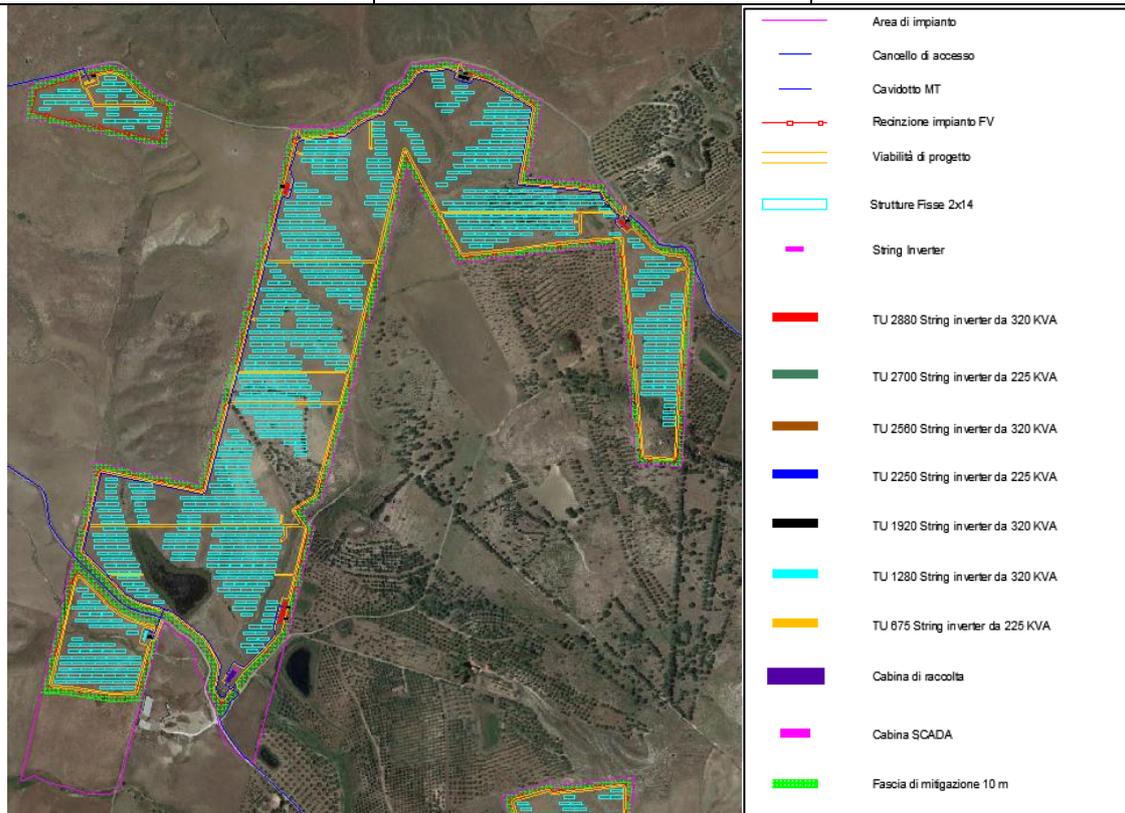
Sovrapposizione su ortofoto del layout di impianto – Lotto 4
